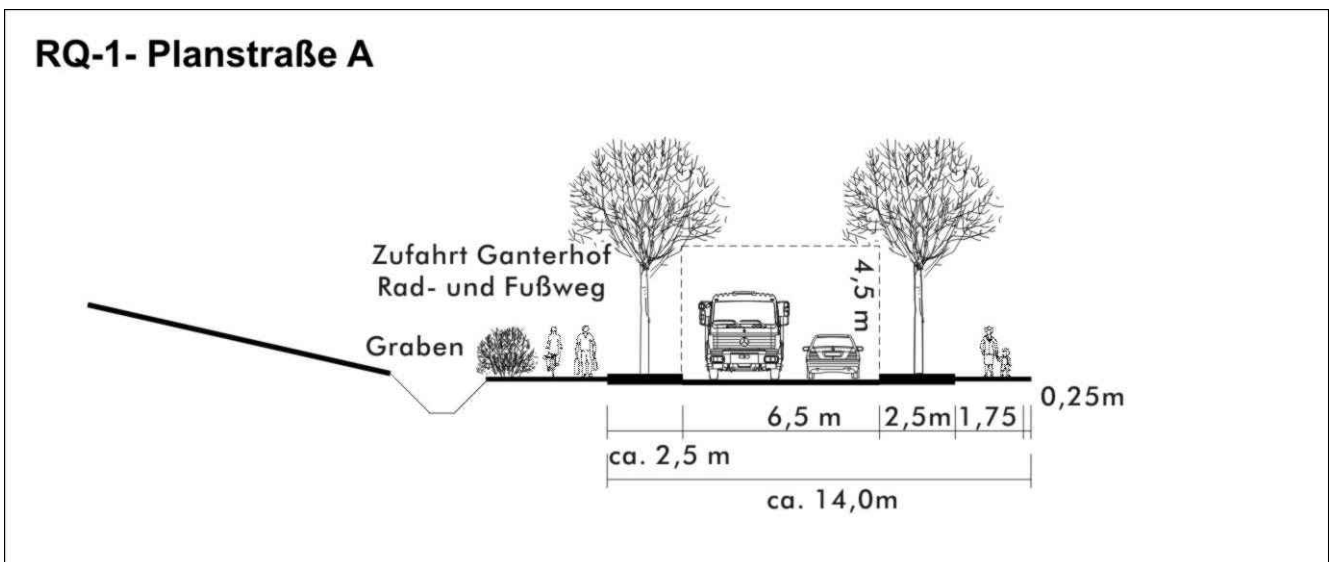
Schemaquerschnitt Sammelstraße (Planstraße A)
